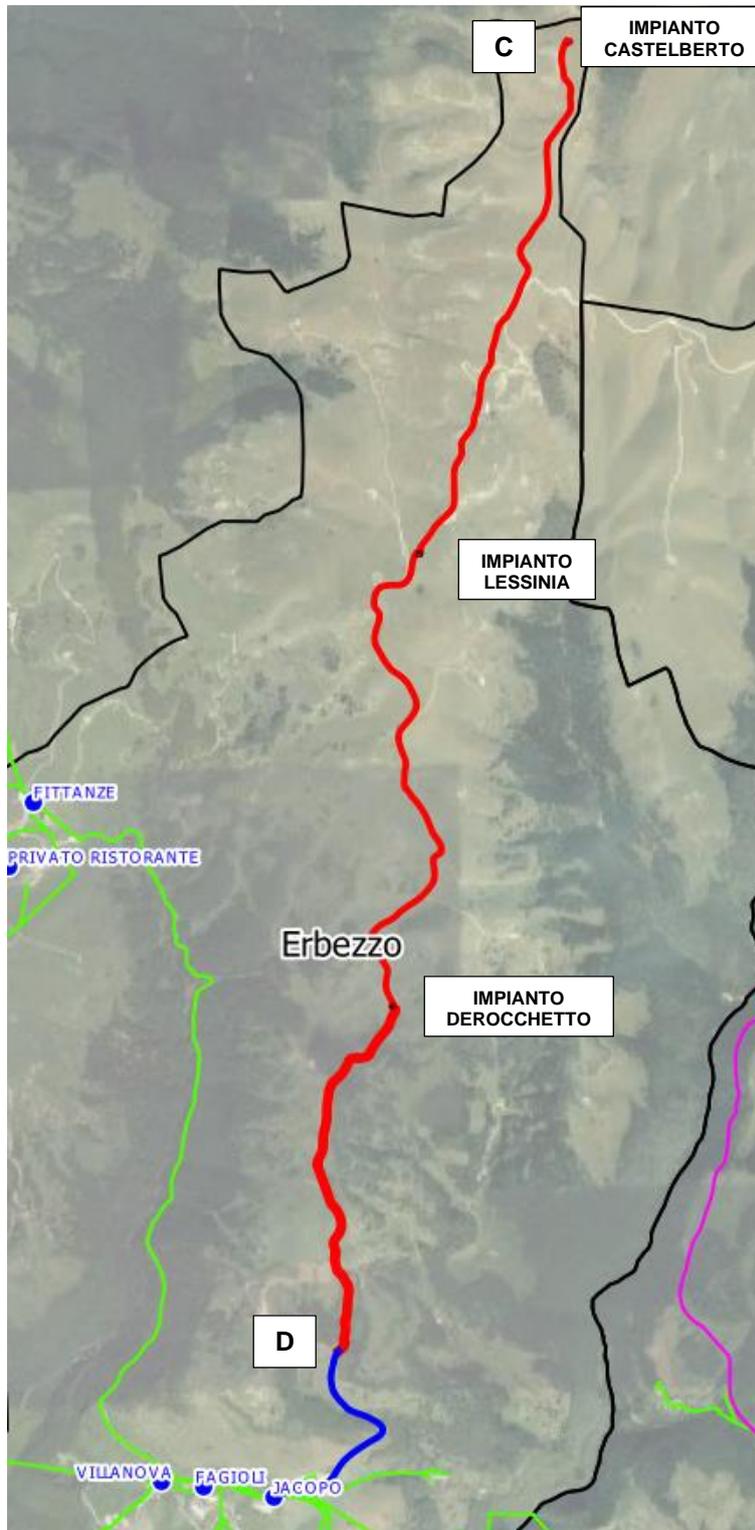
Planimetria generale del tracciato CD. In rosso il tracciato di progetto, in blu il tracciato oggetto di altra progettazione (serb. Jacopo – nodo D), in verde la rete esistente.
